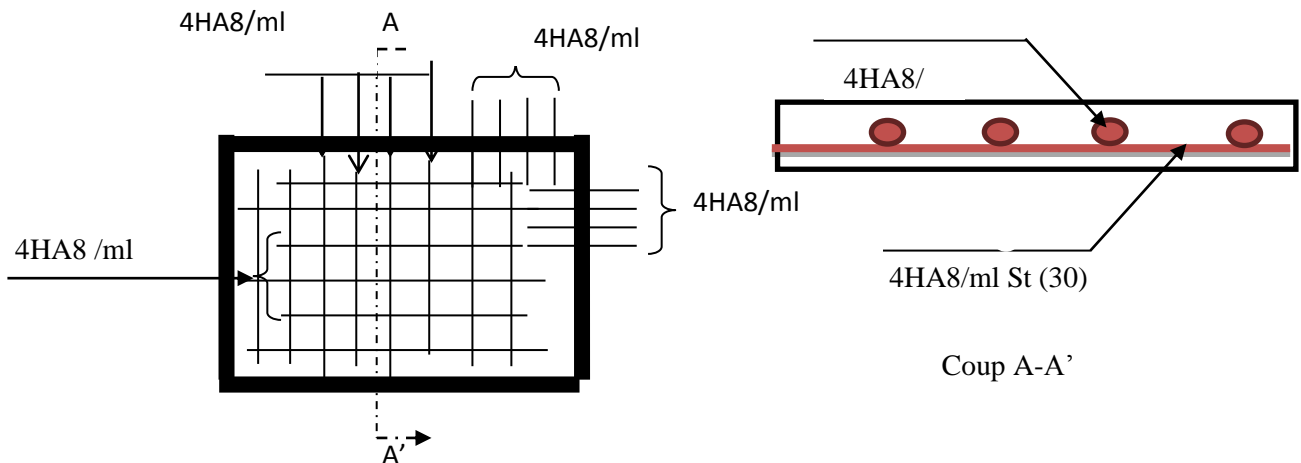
schéma de ferrailage de la dalle au niveau de la cage d'ascenseur
